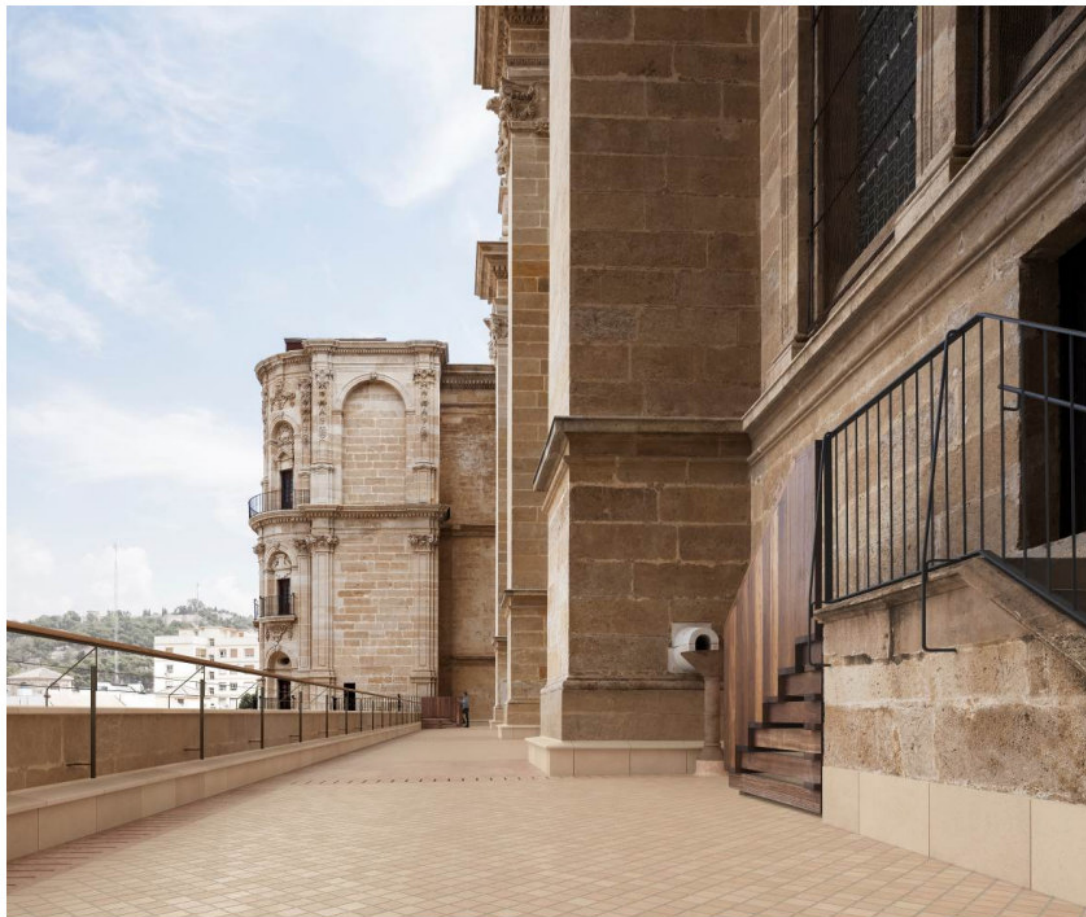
Fotomontaje del pavimento cerámico propuesto en la terraza norte.
